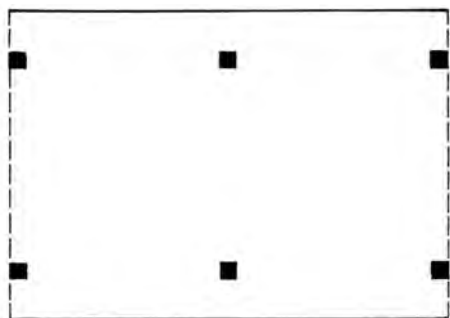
Planta baixa do sistema sem a porção da escada. [FRAMPTON, 1979]:69b
